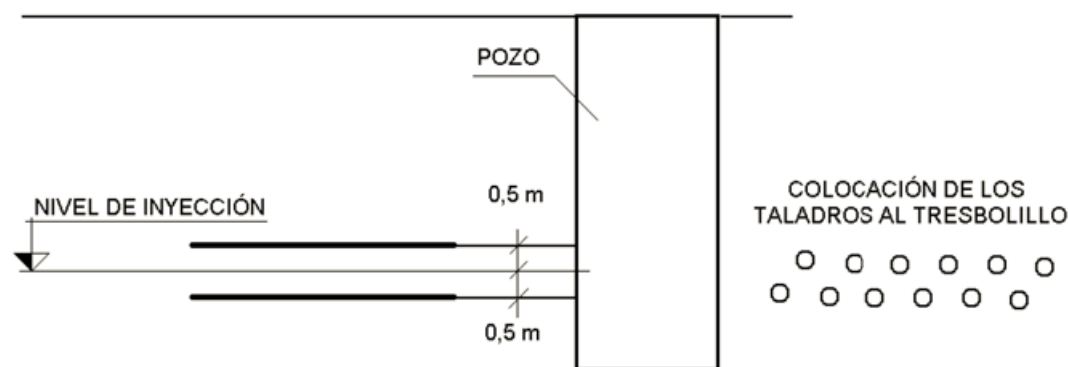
Inyección para acondicionamiento (Pretratamiento).
